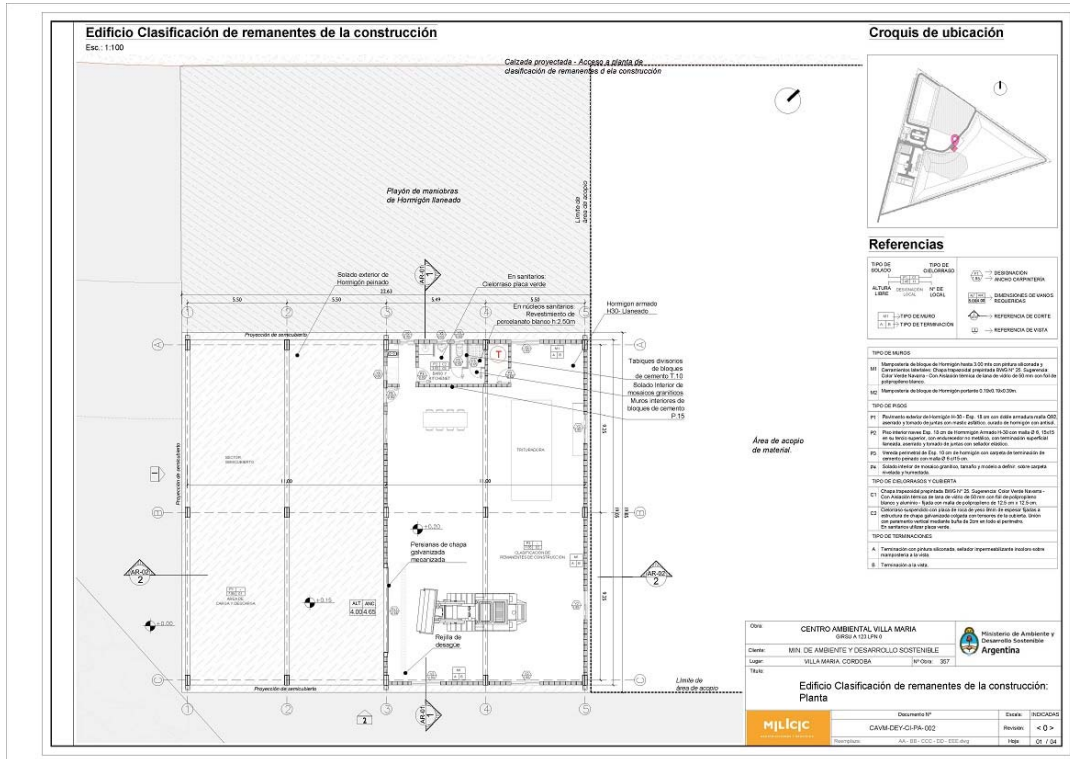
Villa María - Sector Áridos - Planta de Arquitectura.
